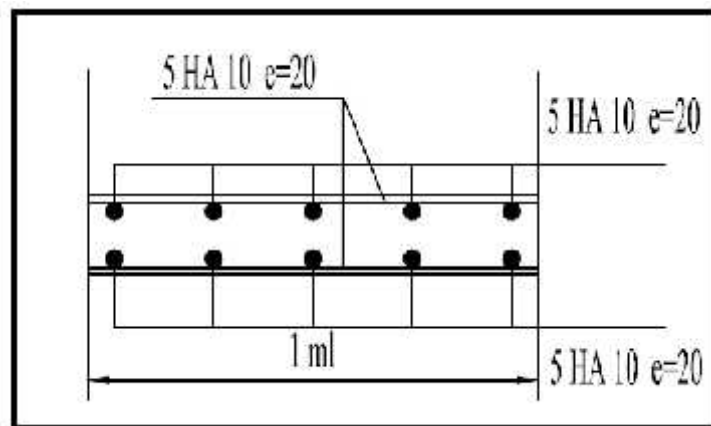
Schéma de ferrailage de la dalle La dalle de l'ascenseur.
